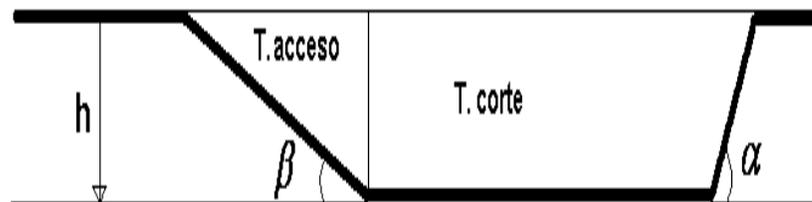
Perfil longitudinal de la trinchera de acceso y de corte
